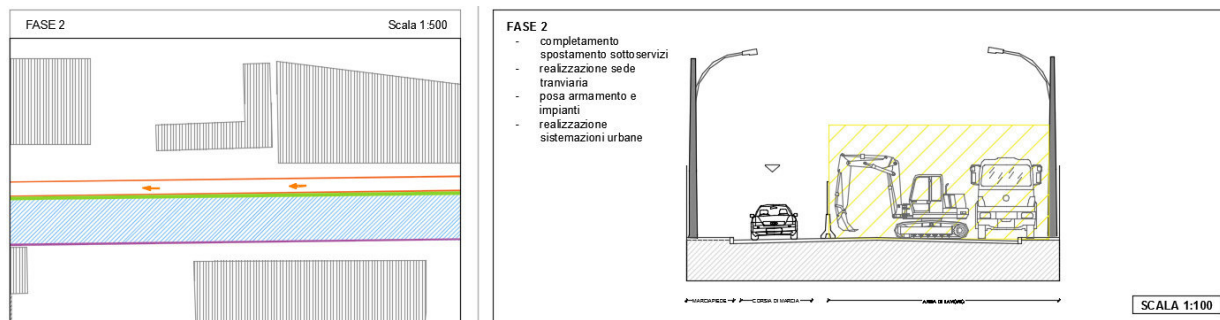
Tipologico cantiere con sede laterale Fase 2
